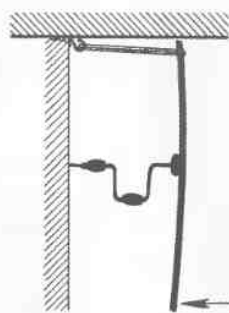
Использование в качестве упора при сверлении бетонной стены рычага и гвоздя (крюка), вбитого в щель между потолочной и стеной панелями
